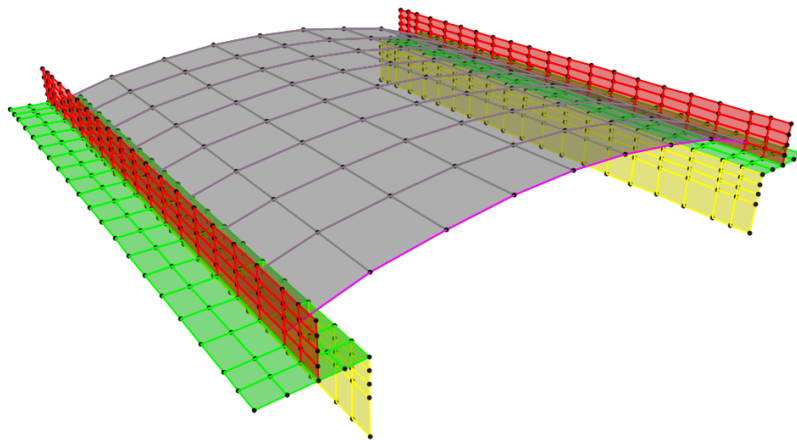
Modelo estrutural da ponte modelada em Plaxis.
